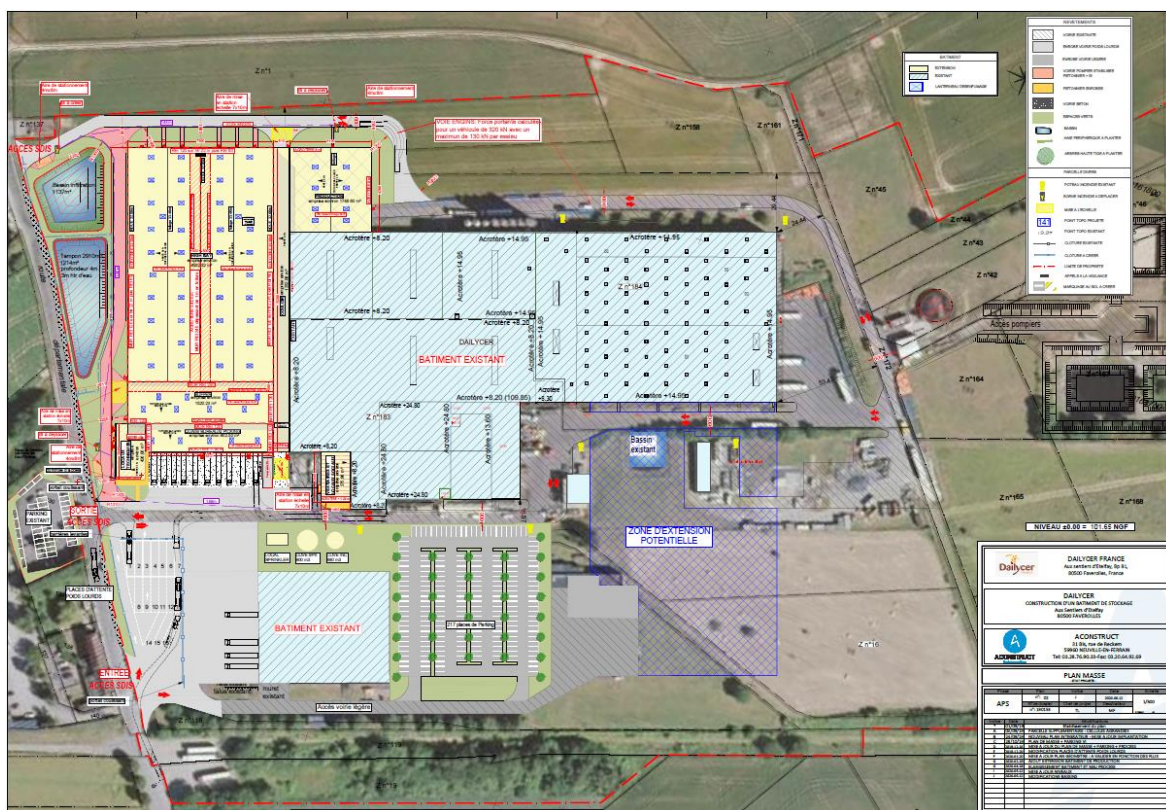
Extrait du plan Masse du projet de réorganisation du site et construction du TK, approuvé le 16/07/2021.
